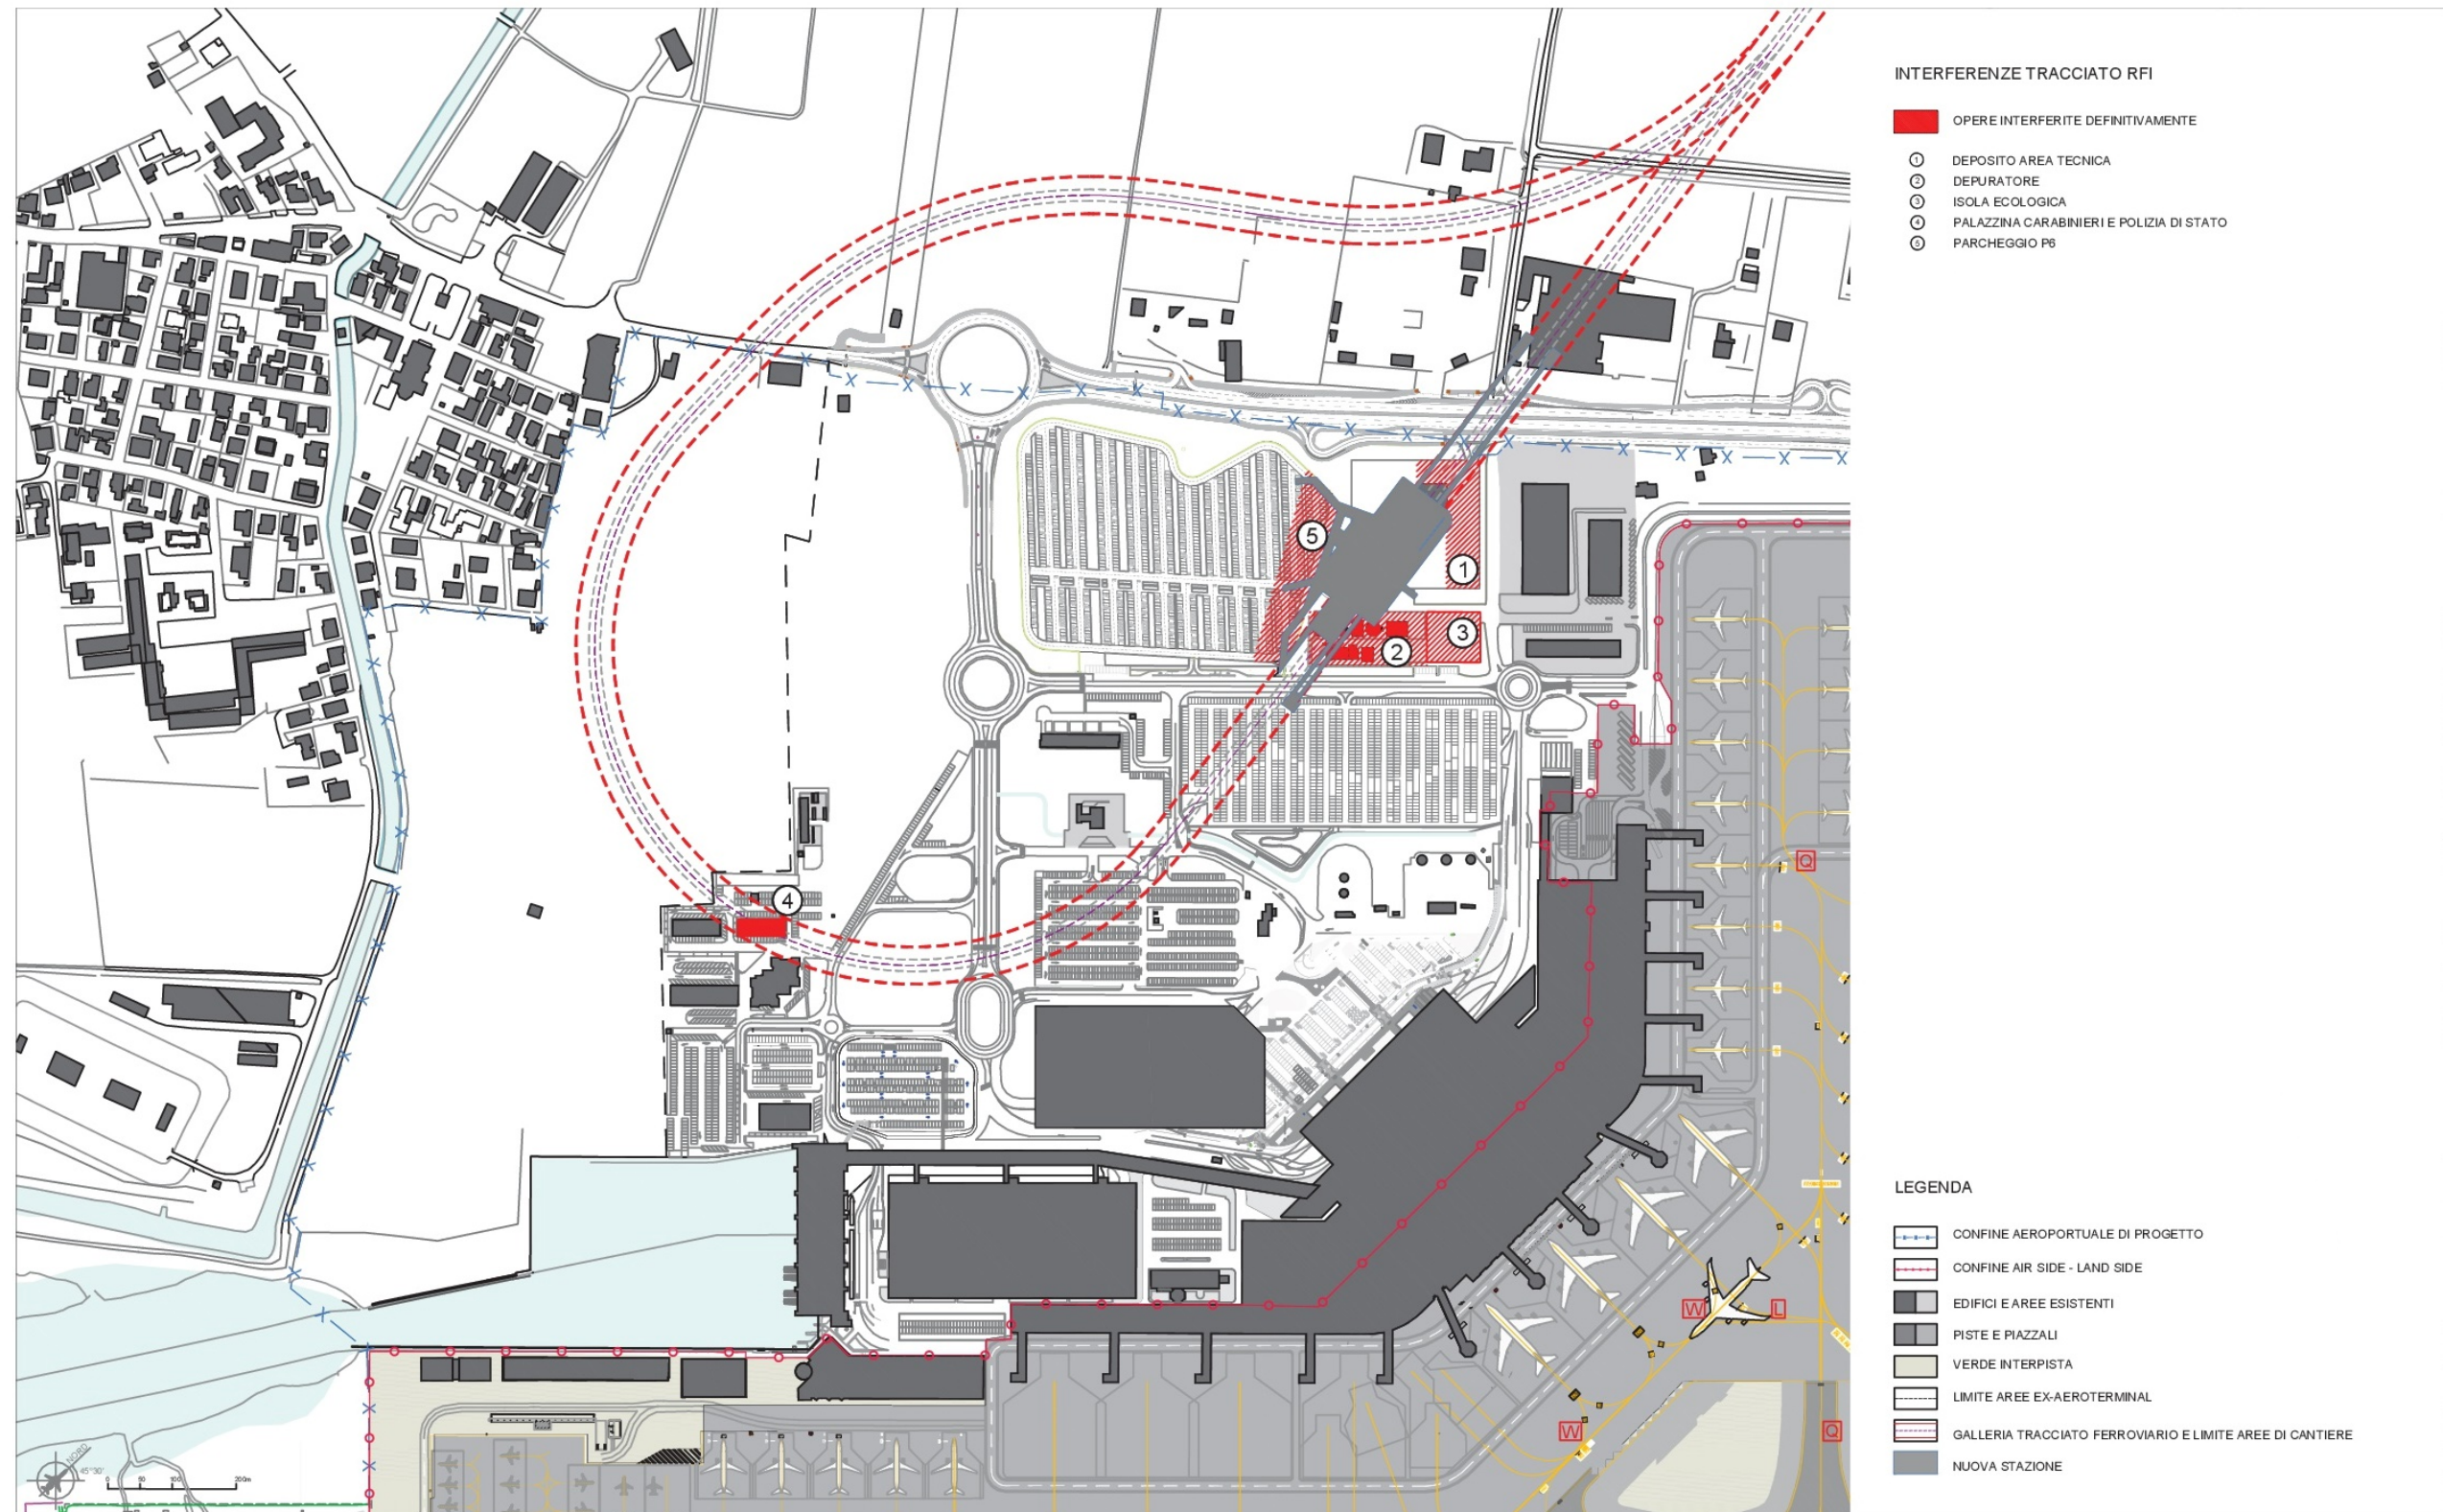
Planimetria con individuazione delle interferenze dirette
